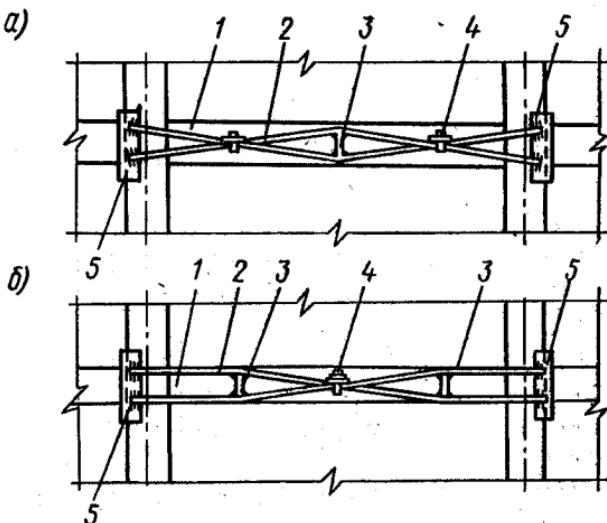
Усиление балки предварительно напряженной дополнительной арматурой:
